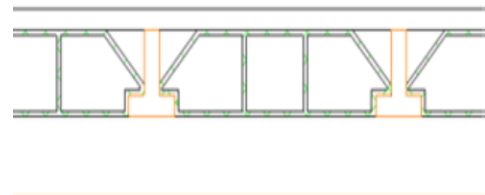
Plancher corps creux .Source : <https://travauxbeton.fr/>
